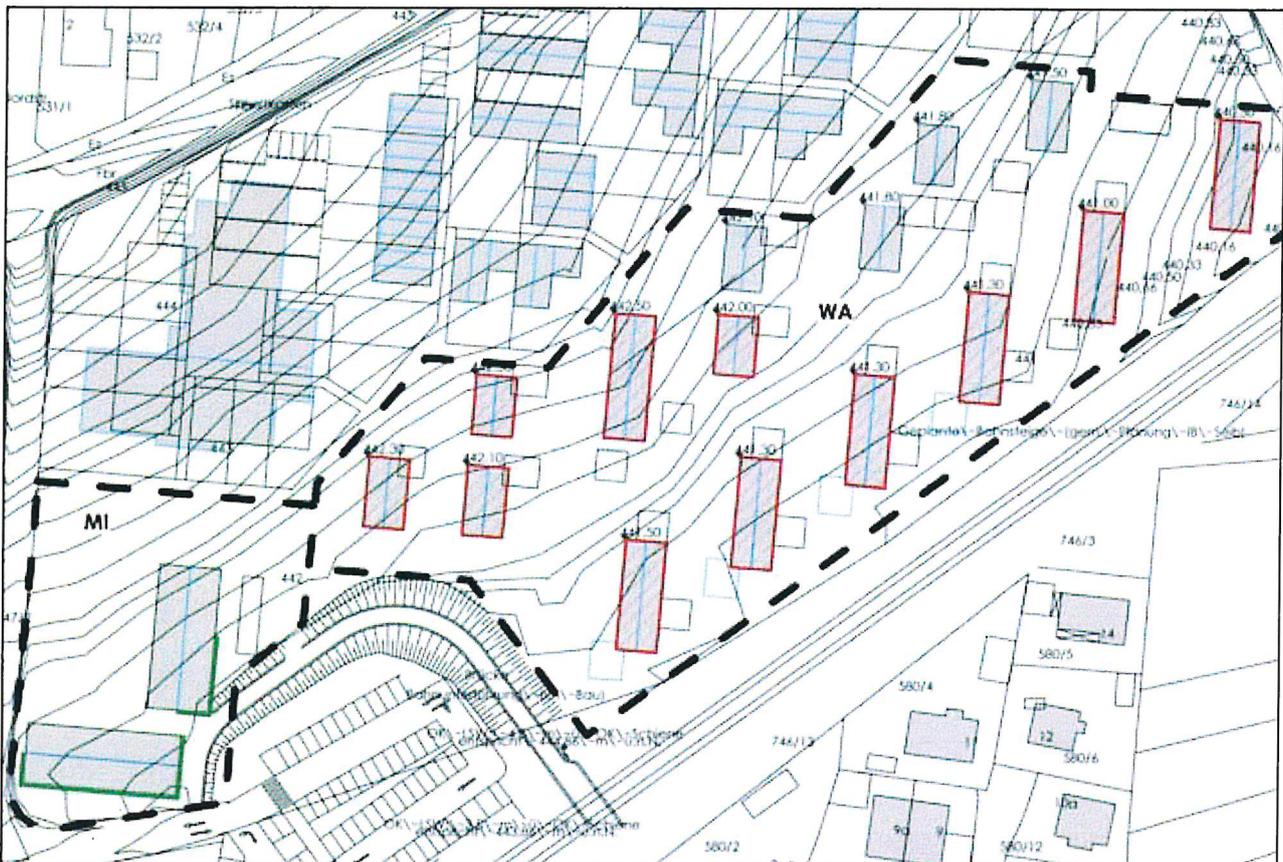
Lageplan M 1:1.500 mit Kennzeichnung der Wohnbaukörper gemäß Festsetzungsvorschlag Nr. 1 und der Fassaden gemäß Festsetzungsvorschlag Nr. 2
